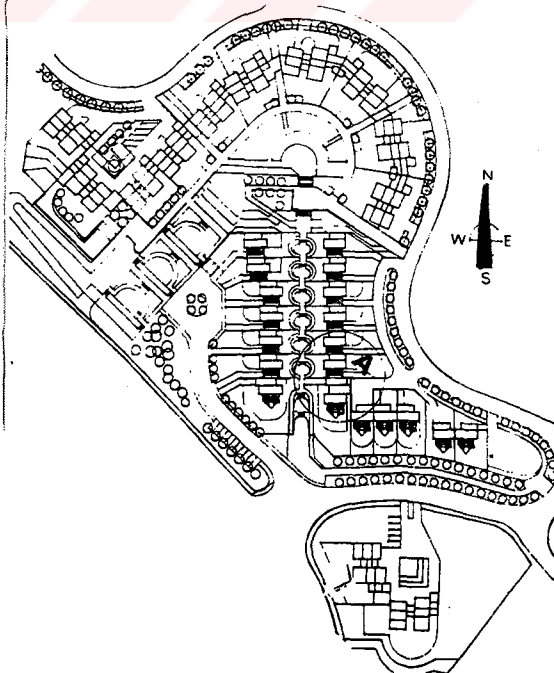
Birincilik ödülü alan projenin vaziyet planı
